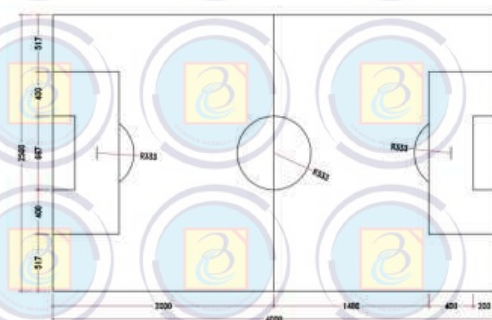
18 Denah, Tampak, Potongan Paint Ball
